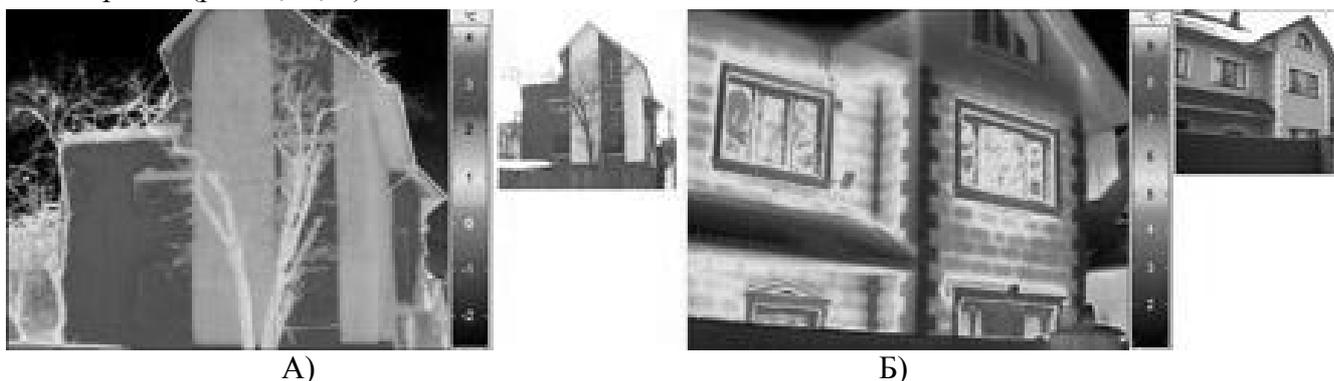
А) термографическое фото здания с двухслойной конструкцией стены (со сплошным качественным наружным утеплением, без мостиков тепла); Б) здание из пеноблоков — однослойная конструкция стены (наглядно видны мостики тепла в углах и швах между пеноблоками)
